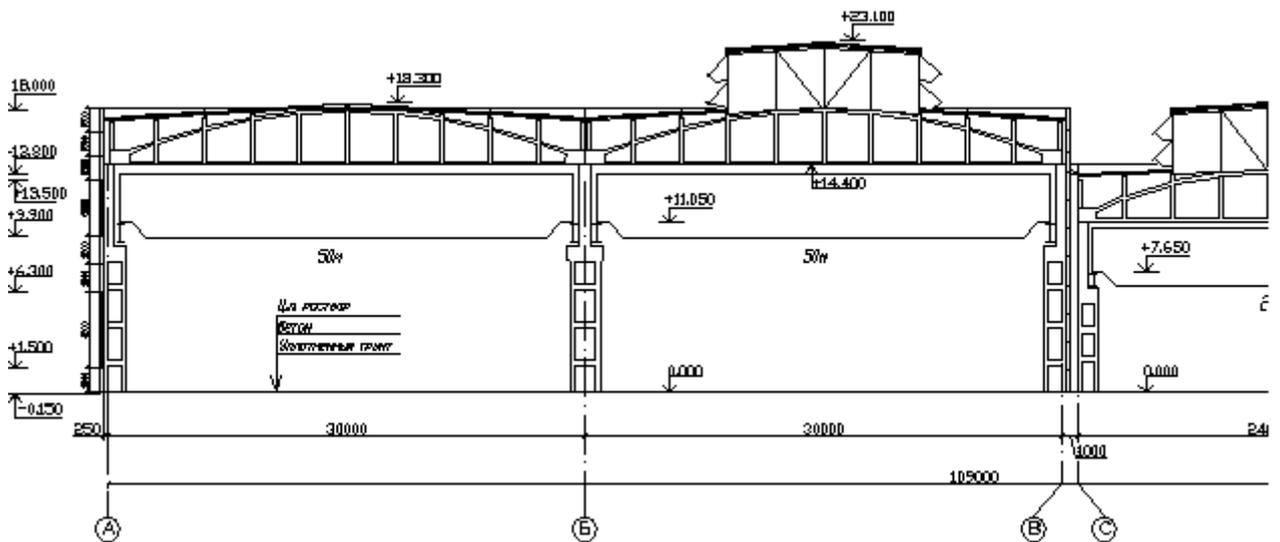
Продольный разрез промздания со связями по колоннам и стропильным конструкциям с привязкой торцевых колонн 250мм.
